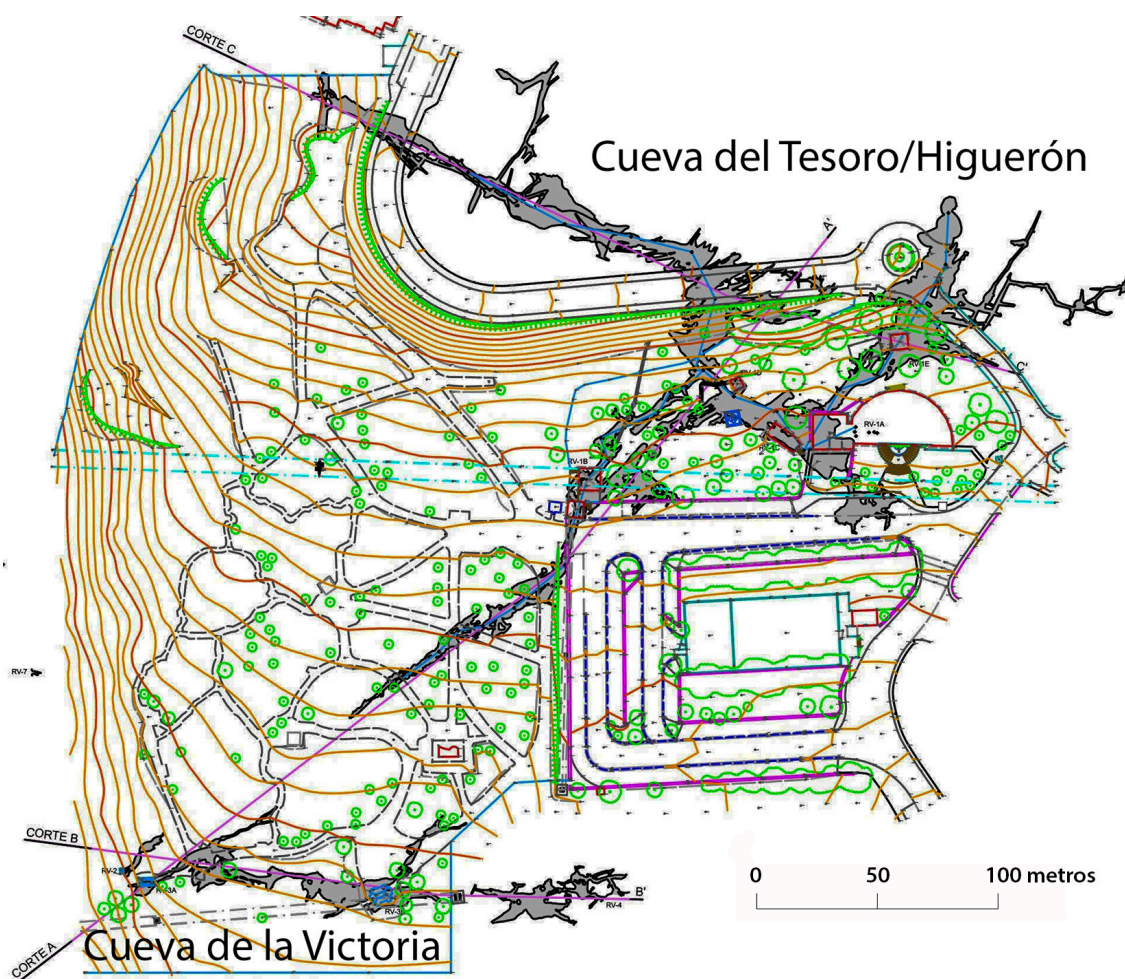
Planimetría del Cantal Alto y situación de las cavidades prehistóricas.
